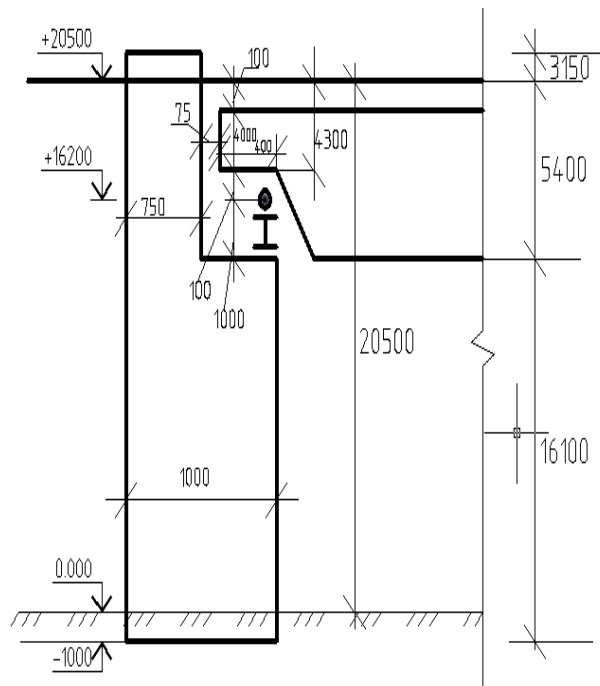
Вертикальне компонування каркаса з розмірами
